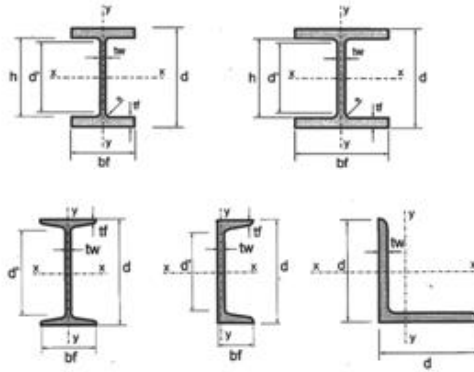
Perfiles de acero estructural de uso frecuente.
